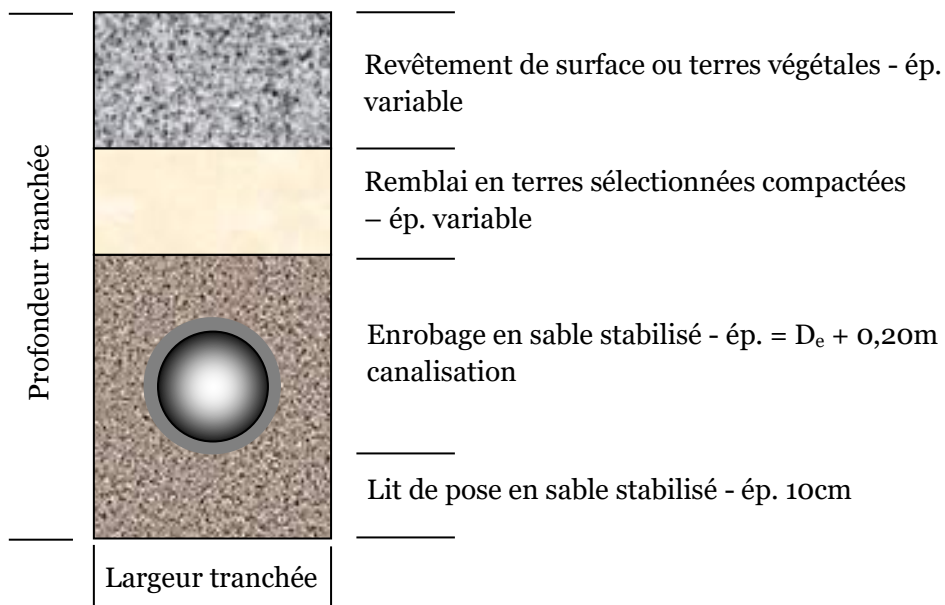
Coupe type pour canalisation de drainage des lixiviats hors casier
